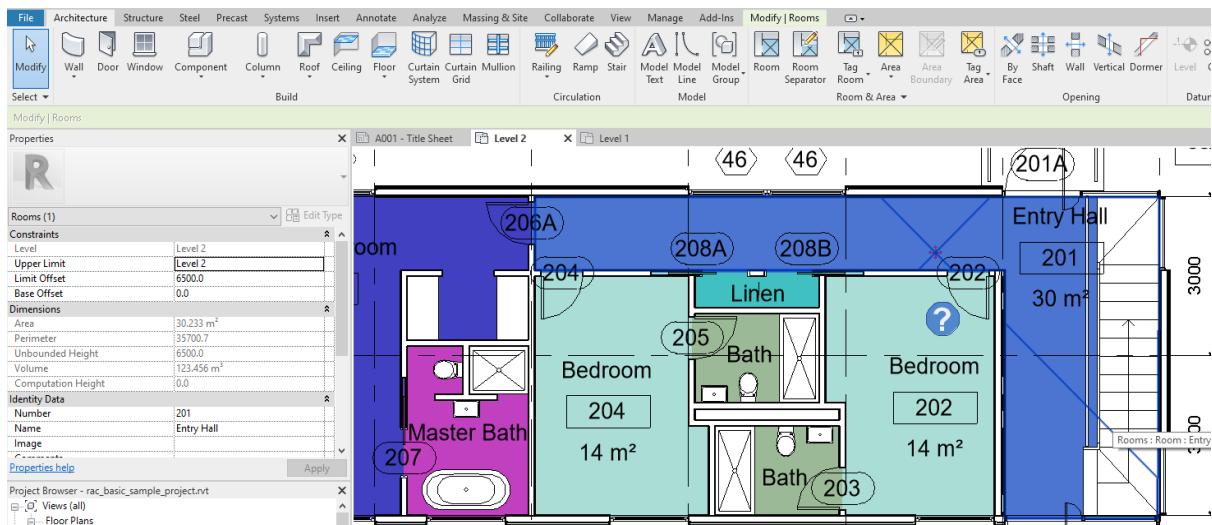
Revit avant modification: La room 'Entry Hall' inclut l'escalier
